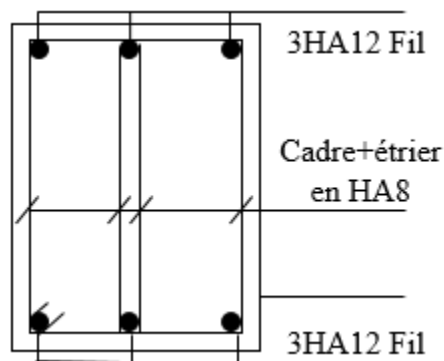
Ferraillage en travée d'une poutre de chaînage.
